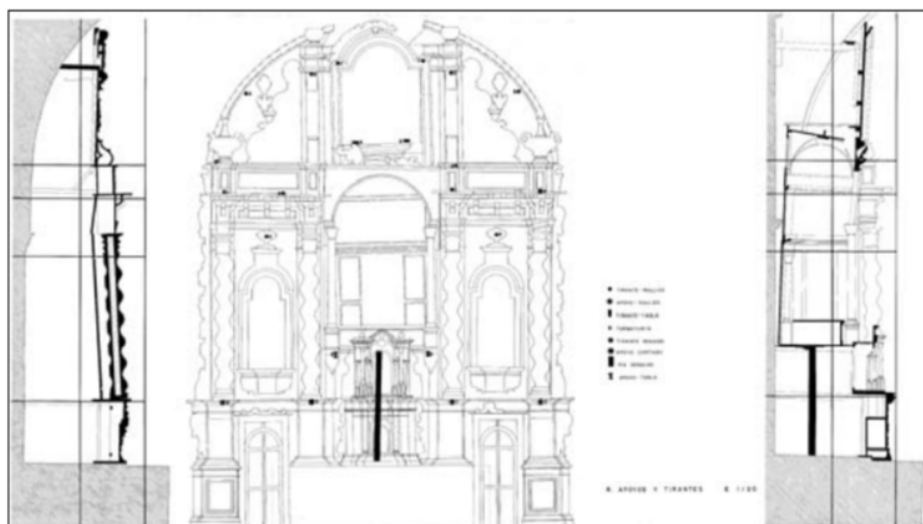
Levantamiento planimétrico y definición de elementos estructurales. Retablo Mayor de la Iglesia Parroquial de Alcalá del Río.
